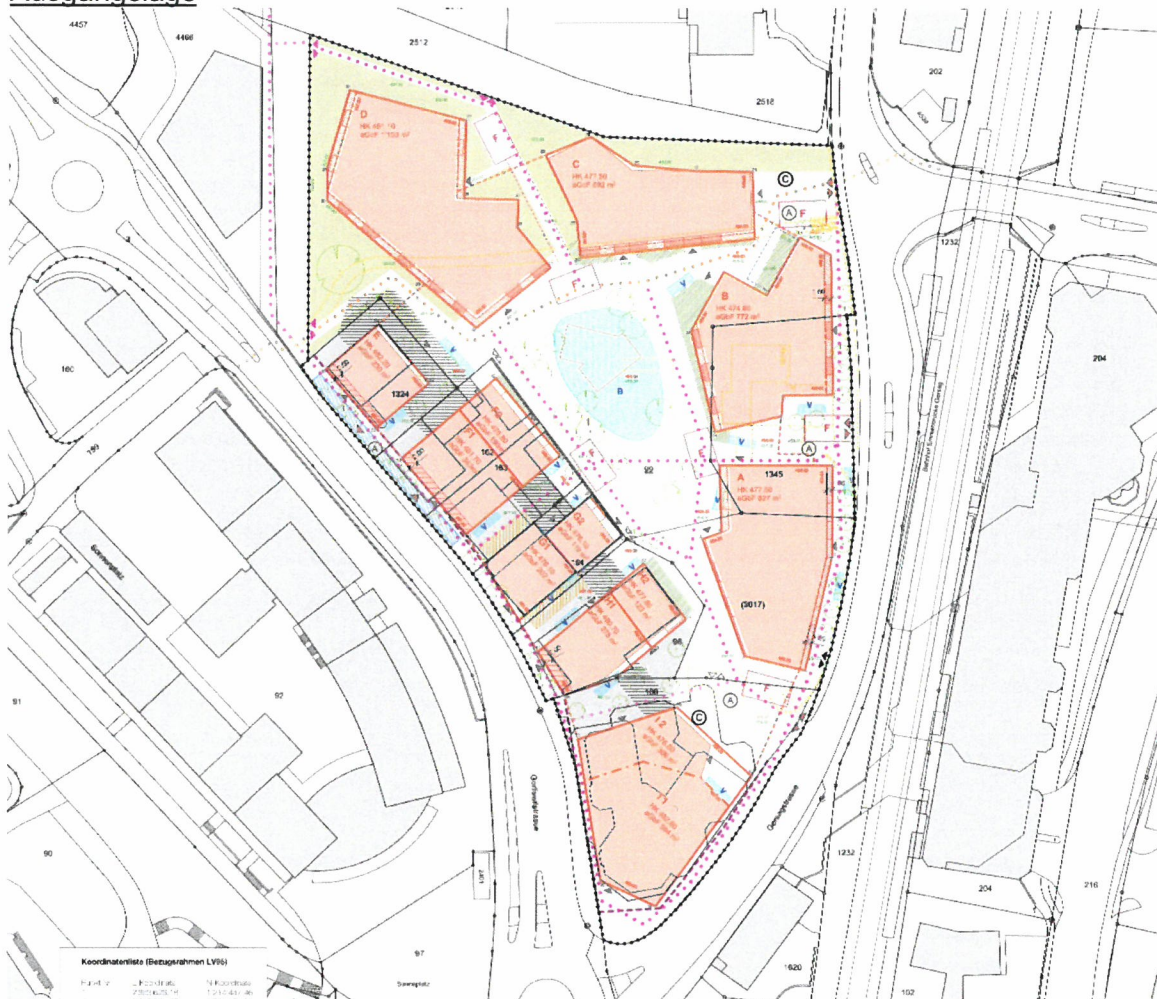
Ausschnitt Situationsplan Bebauungsplan «Sonne» (Stand 12.08.2020)
